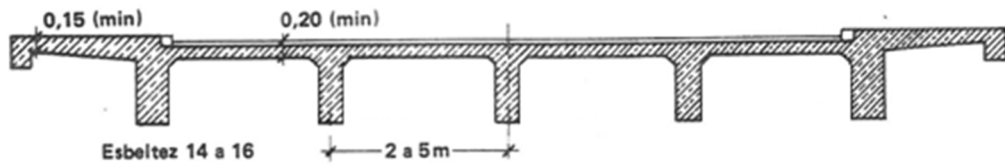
Superestrutura em viga com várias vigas (LEONHARDT, 1979)
